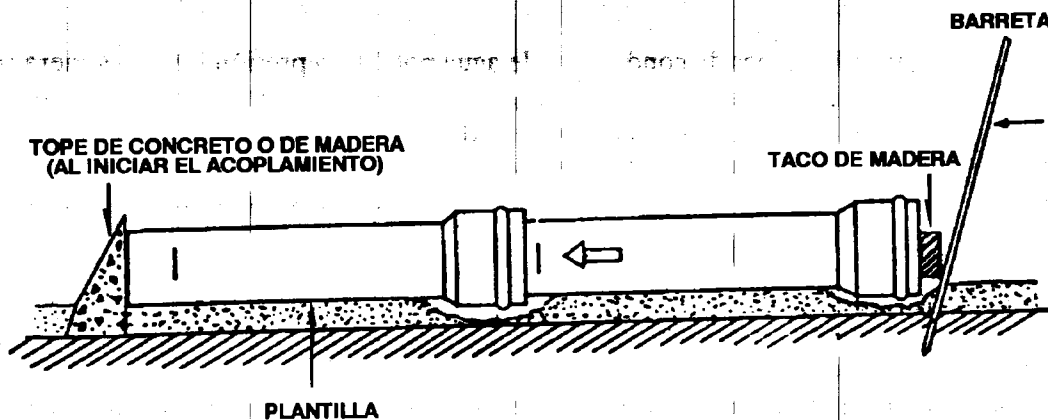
Acoplamiento de tubería de PVC dentro de la zanja
